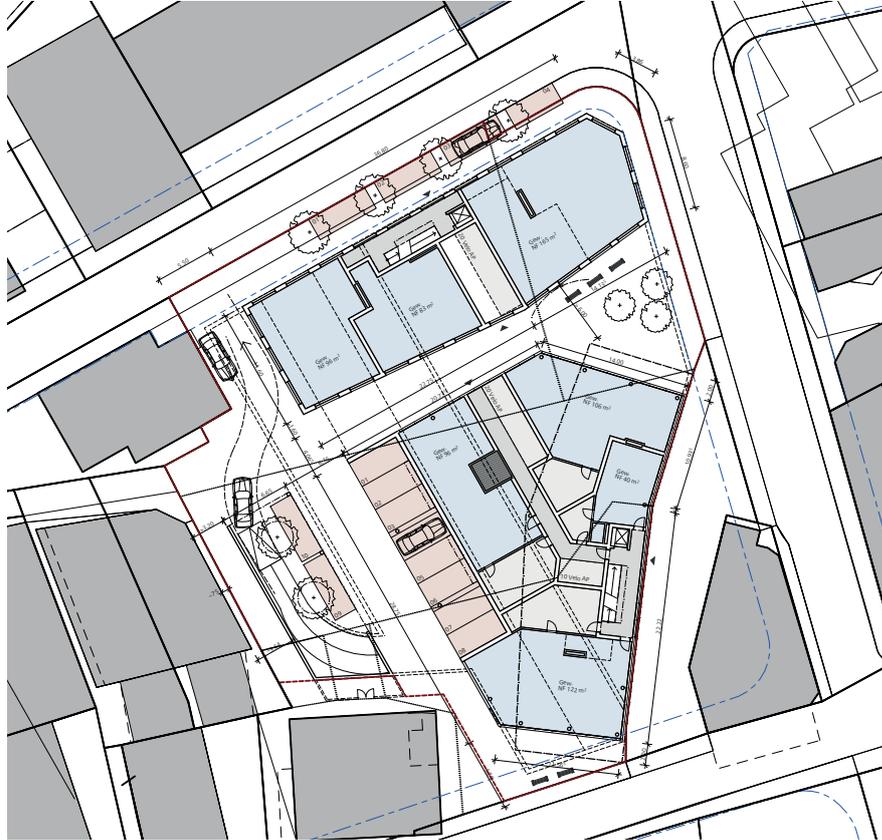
Erdgeschoss mit Gewerbenutzung und öffentlich zugängliche Aussenräume auf Strassenniveau mit öffentlichen Parkplätzen
